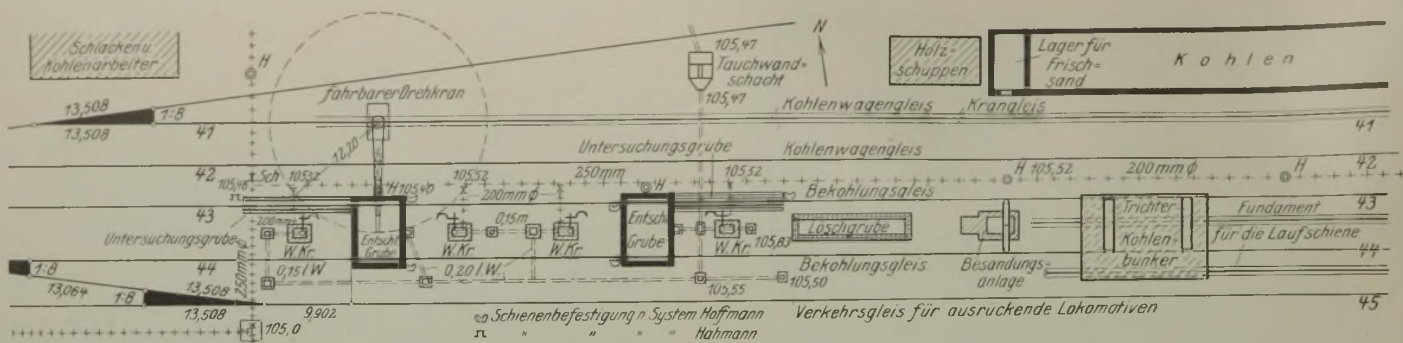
Lageplan der Bekohlungs- und Entschlackungsanlage.
